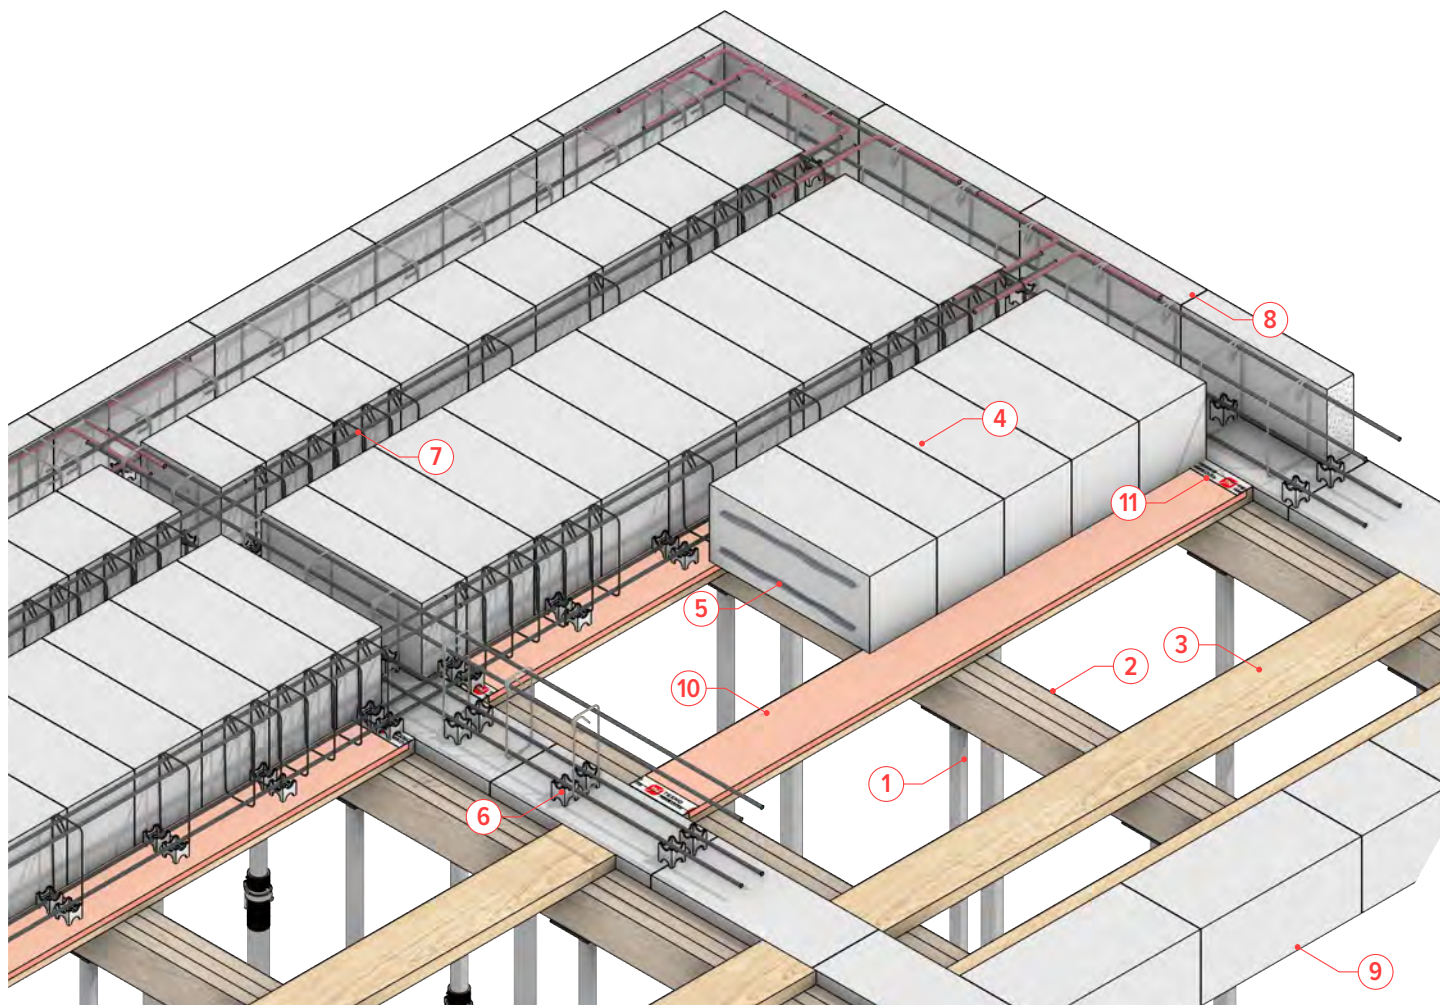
Сборка сборно-монолитного перекрытия до бетонирования
